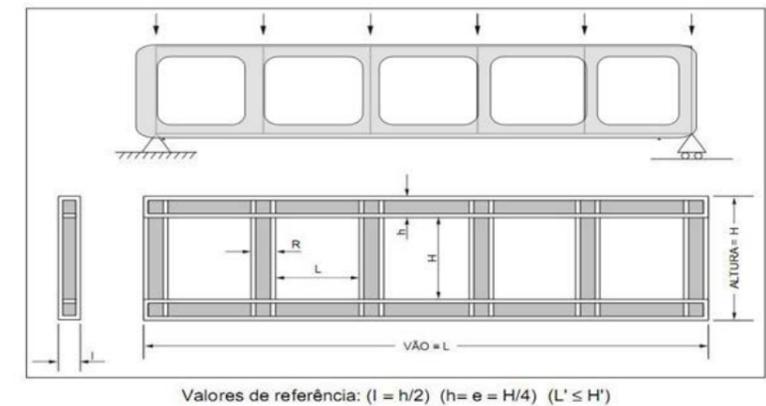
Esquema Vigas habitables Tomado de (Hugon, M. Serre, 1982.)
